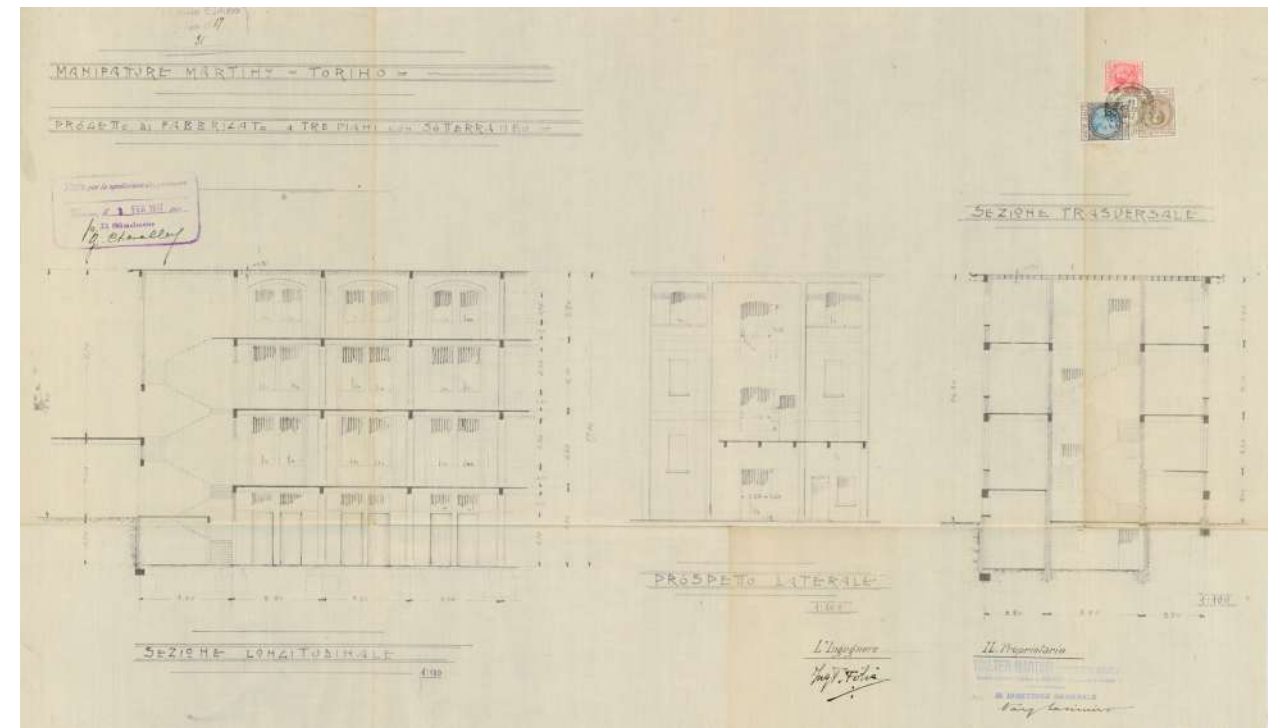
Pratica edilizia 1917. Source: Archivio storico citta' di Torino.
